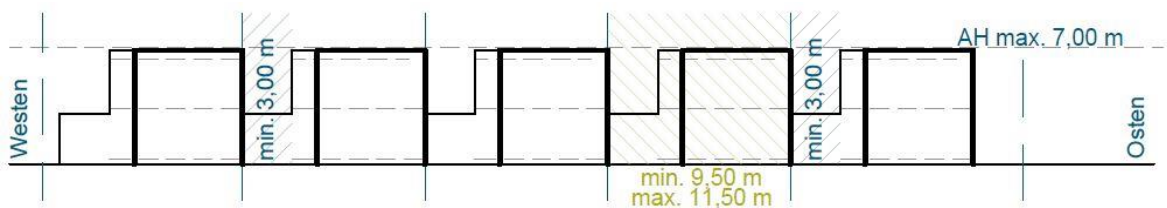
Darstellung der abweichenden Bauweise für Gebäude mit Flachdach – ohne Maßstab
